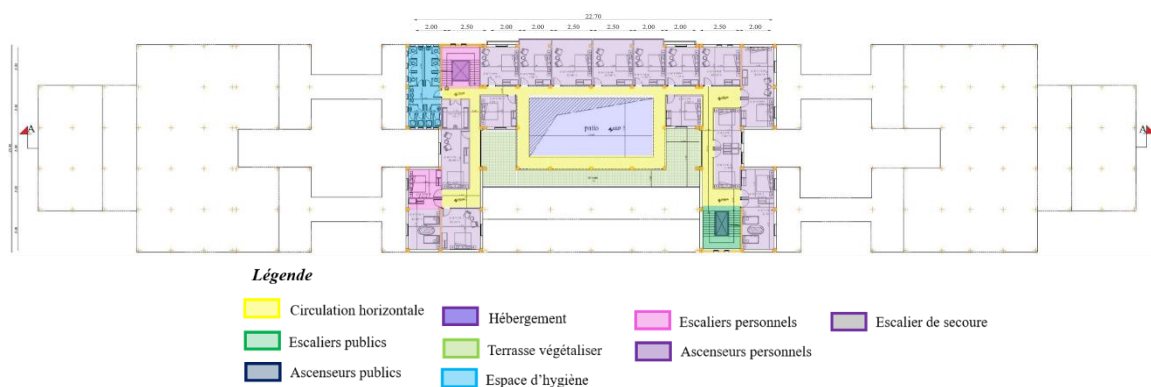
Vue en plan sur deuxième étage (Niveau+10.03)
